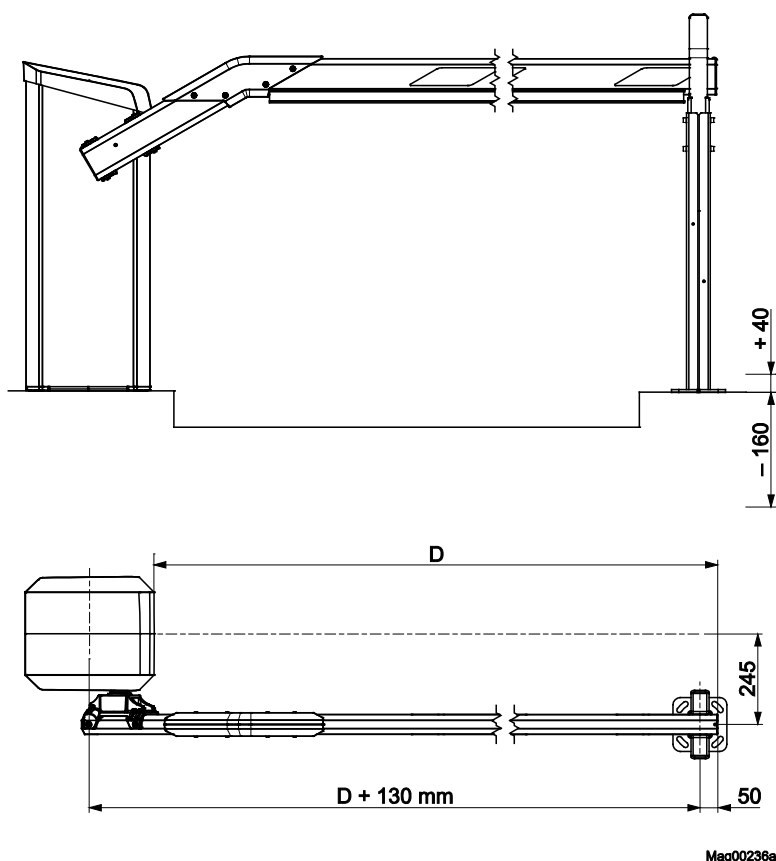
Abmessungen Schrankengehäuse – Pfosten (Maße in mm)
